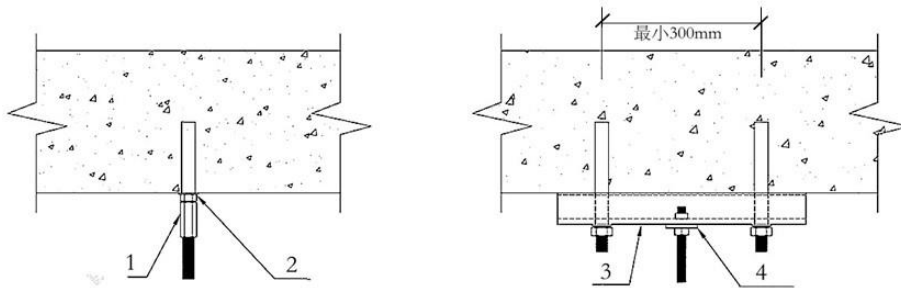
吊杆根部构造示意图（钢筋混凝土结构）
